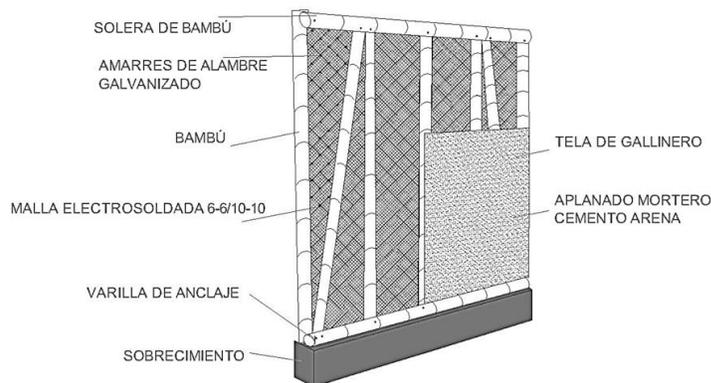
Recubrimiento en muros de vivienda
